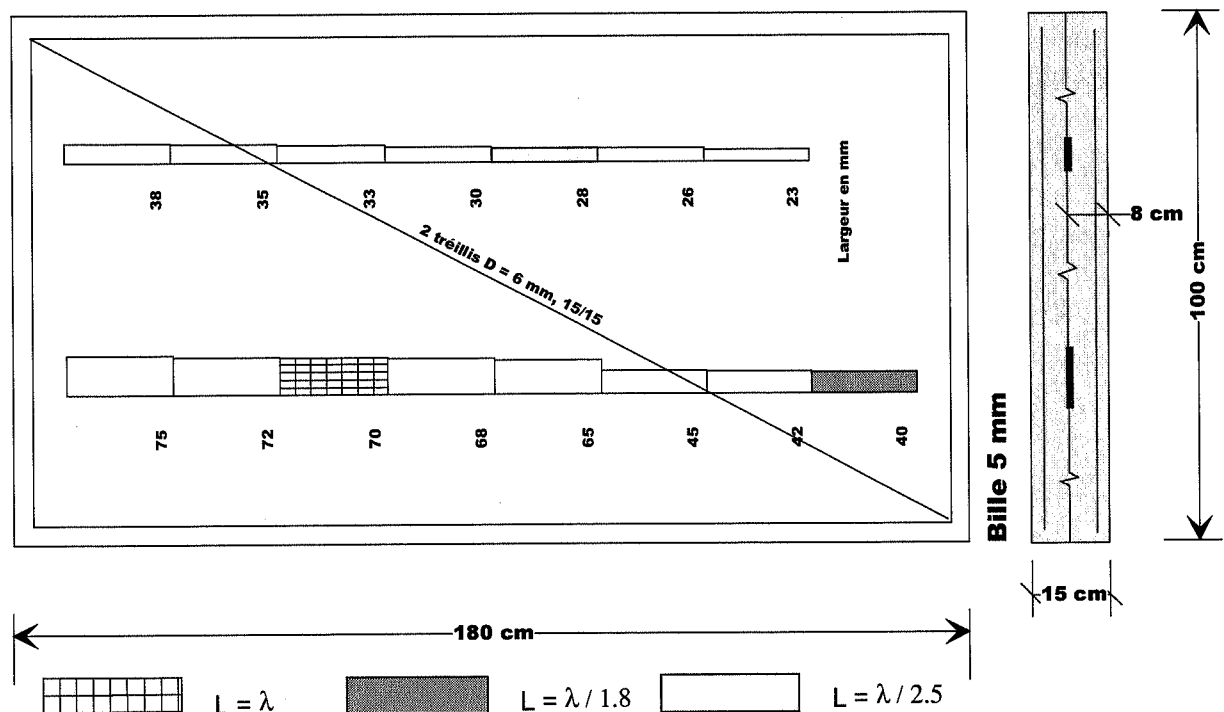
Plan de coffrage et d'armature d'une dalle avec délaminations prévues pour une bille $\varnothing 5$ mm
